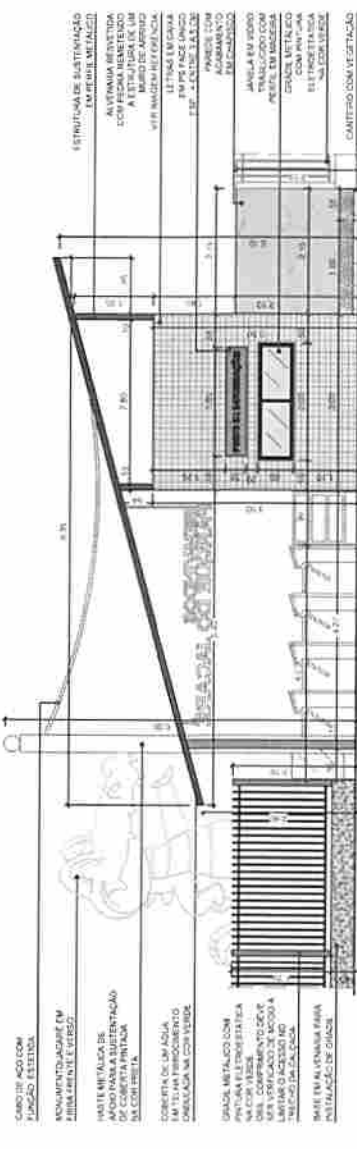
IMAGEM REFERÊNCIA - MURO DE ARRIBO
